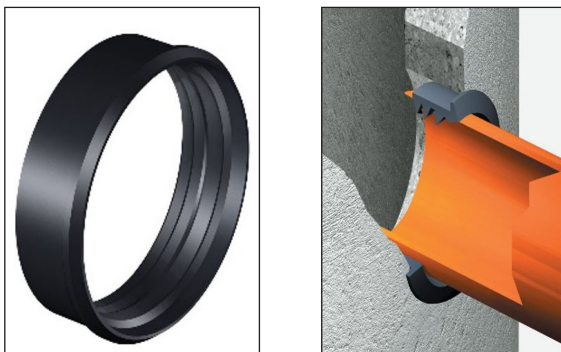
Aansluitopening met inlaatmof van kunststof (Bron: Martens Beton)
